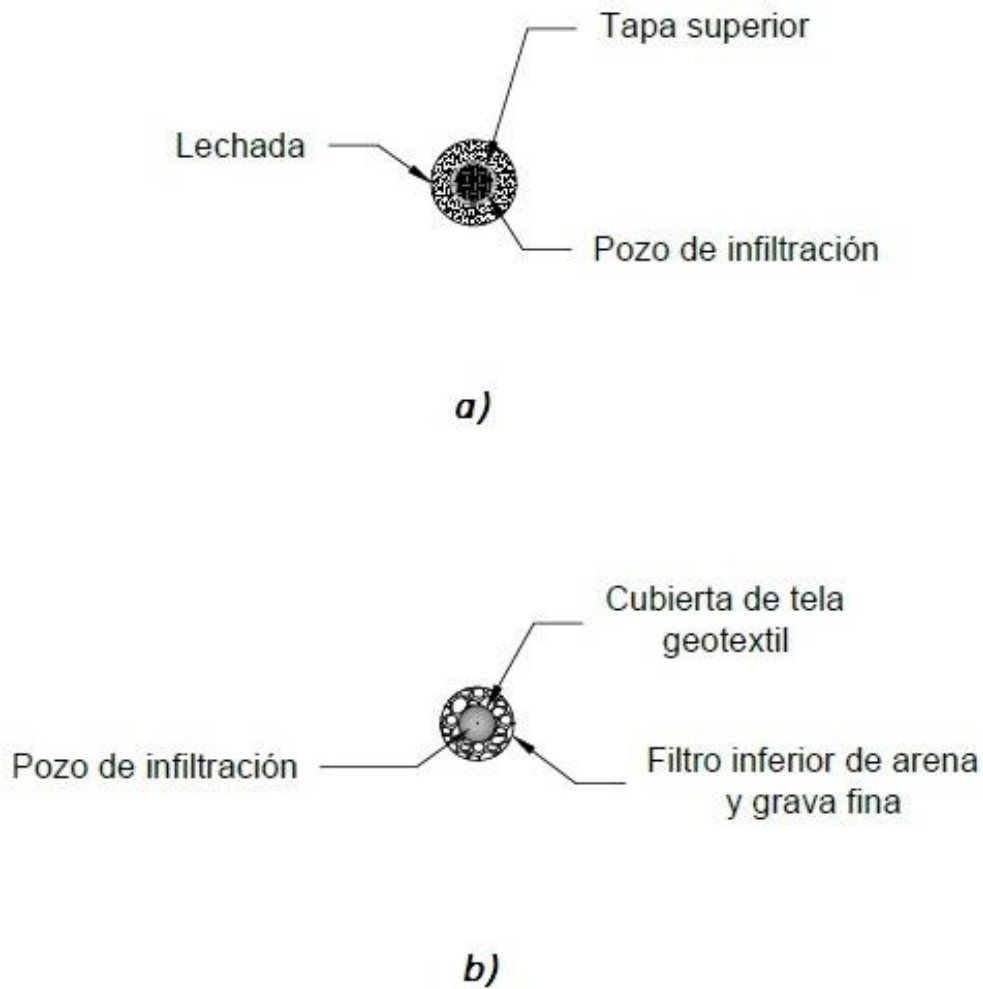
Pozo de infiltración; *a)* vista planta superior, *b)* vista planta inferior
